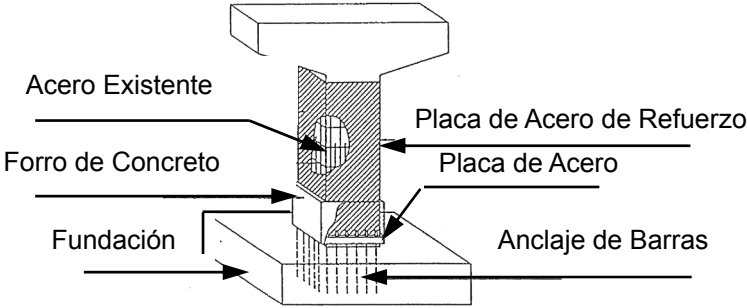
Proceso de Construcción para Encamisado de Concreto
